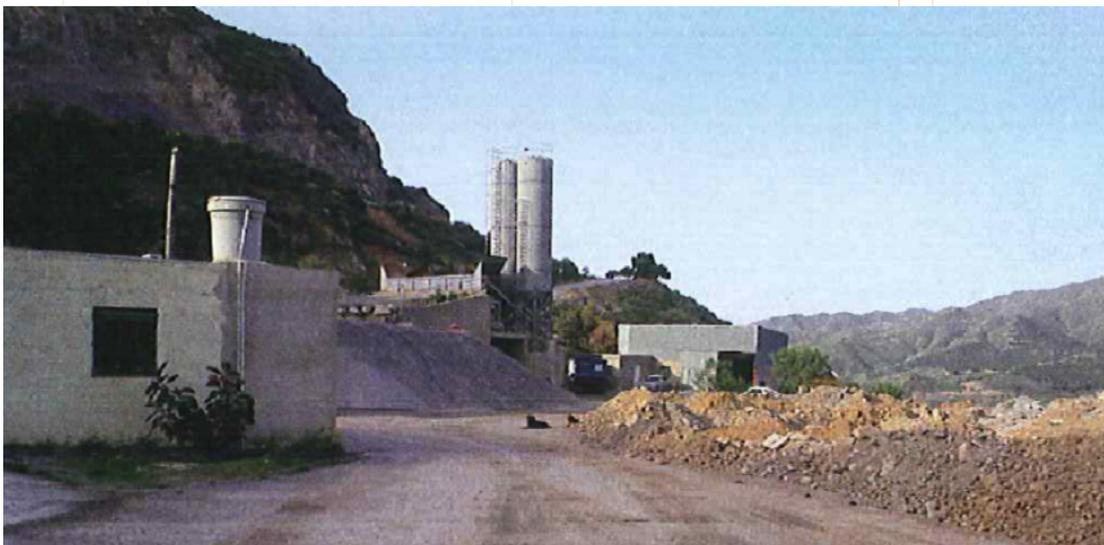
Vista general del paso de la Pala-Cargadora, con la oficina de pesaje a la izquierda y la nave de la planta al fondo.
